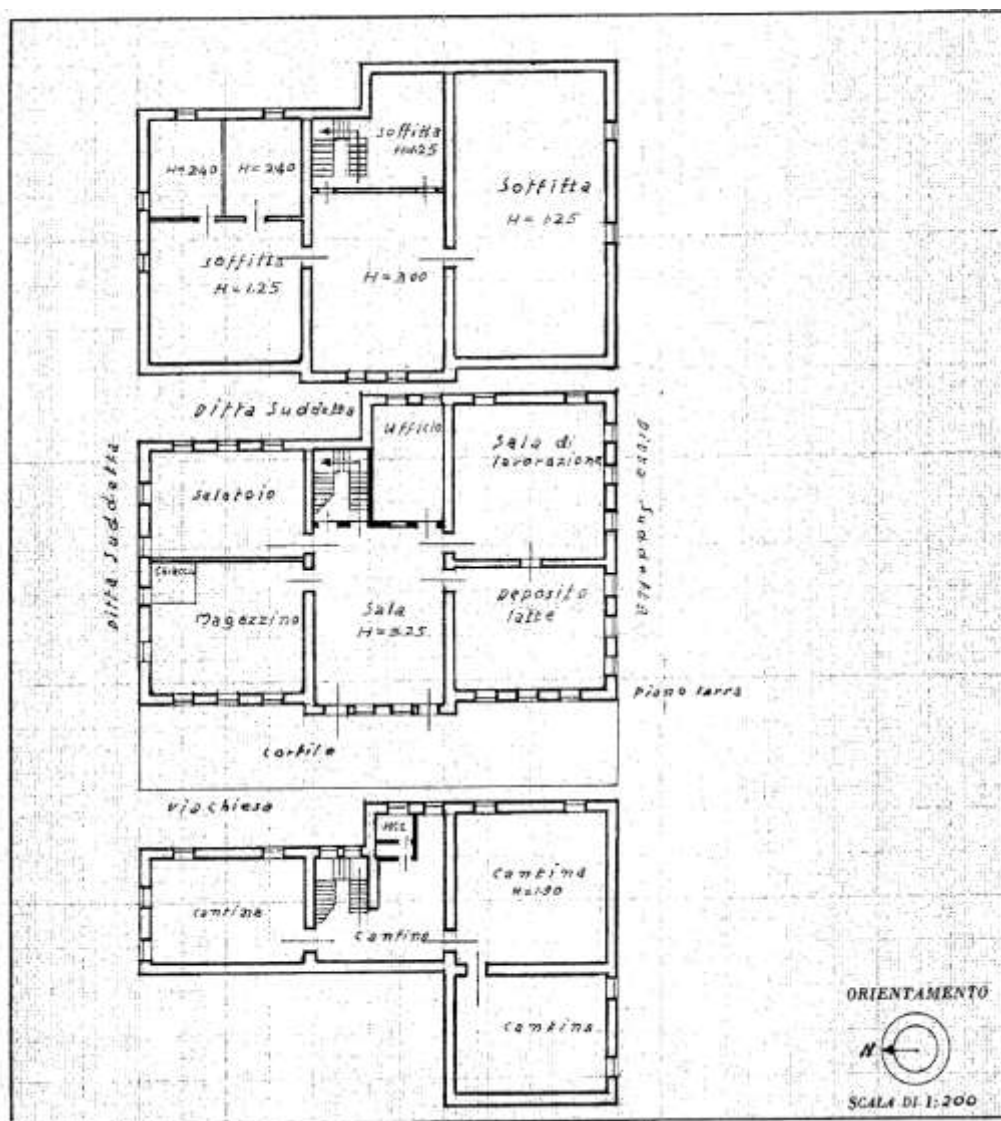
Estratto scheda catastale (fuori scala) – ([Allegato N.3](#))
